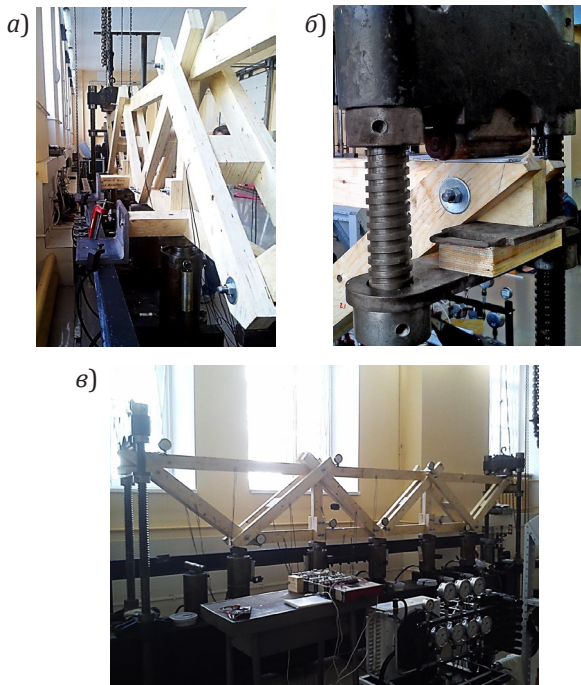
Испытуемая ферма: а – раскрепление из плоскости верхнего пояса фермы; б – опорный узел фермы; в – внешний вид конструкции
